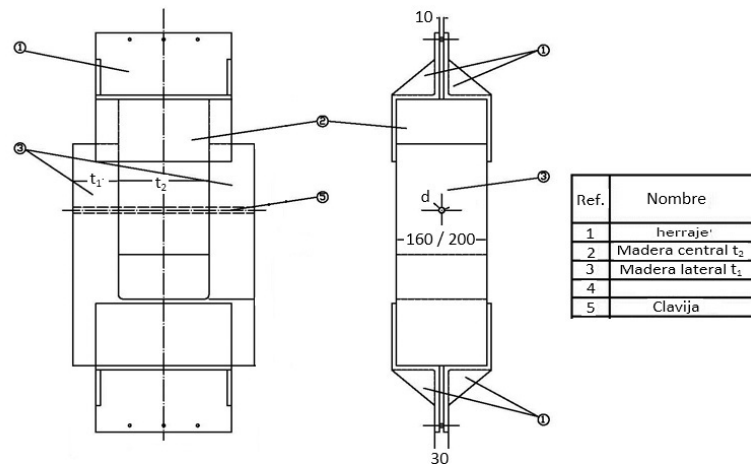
Extracto de planos de diseño y montaje de herrajes con probetas.
